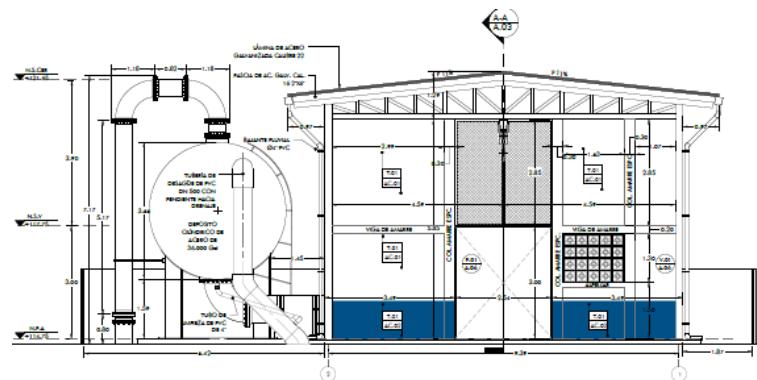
EBAP San Lorenzo (pendiente construir)
